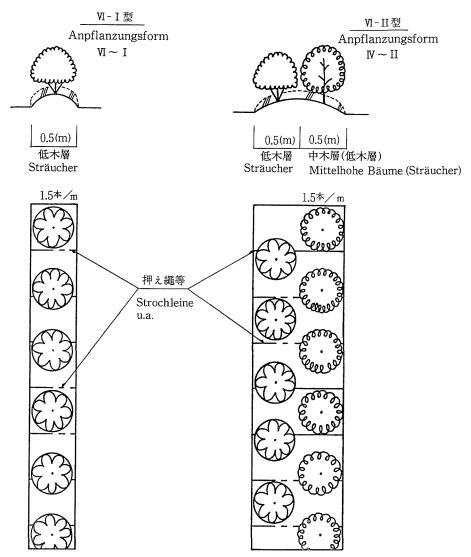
植栽形式 YI の植栽断面および平面図 Pflanzungsprofil (oben) und Grundriß (unten) von Anpflanzungsform VI.
